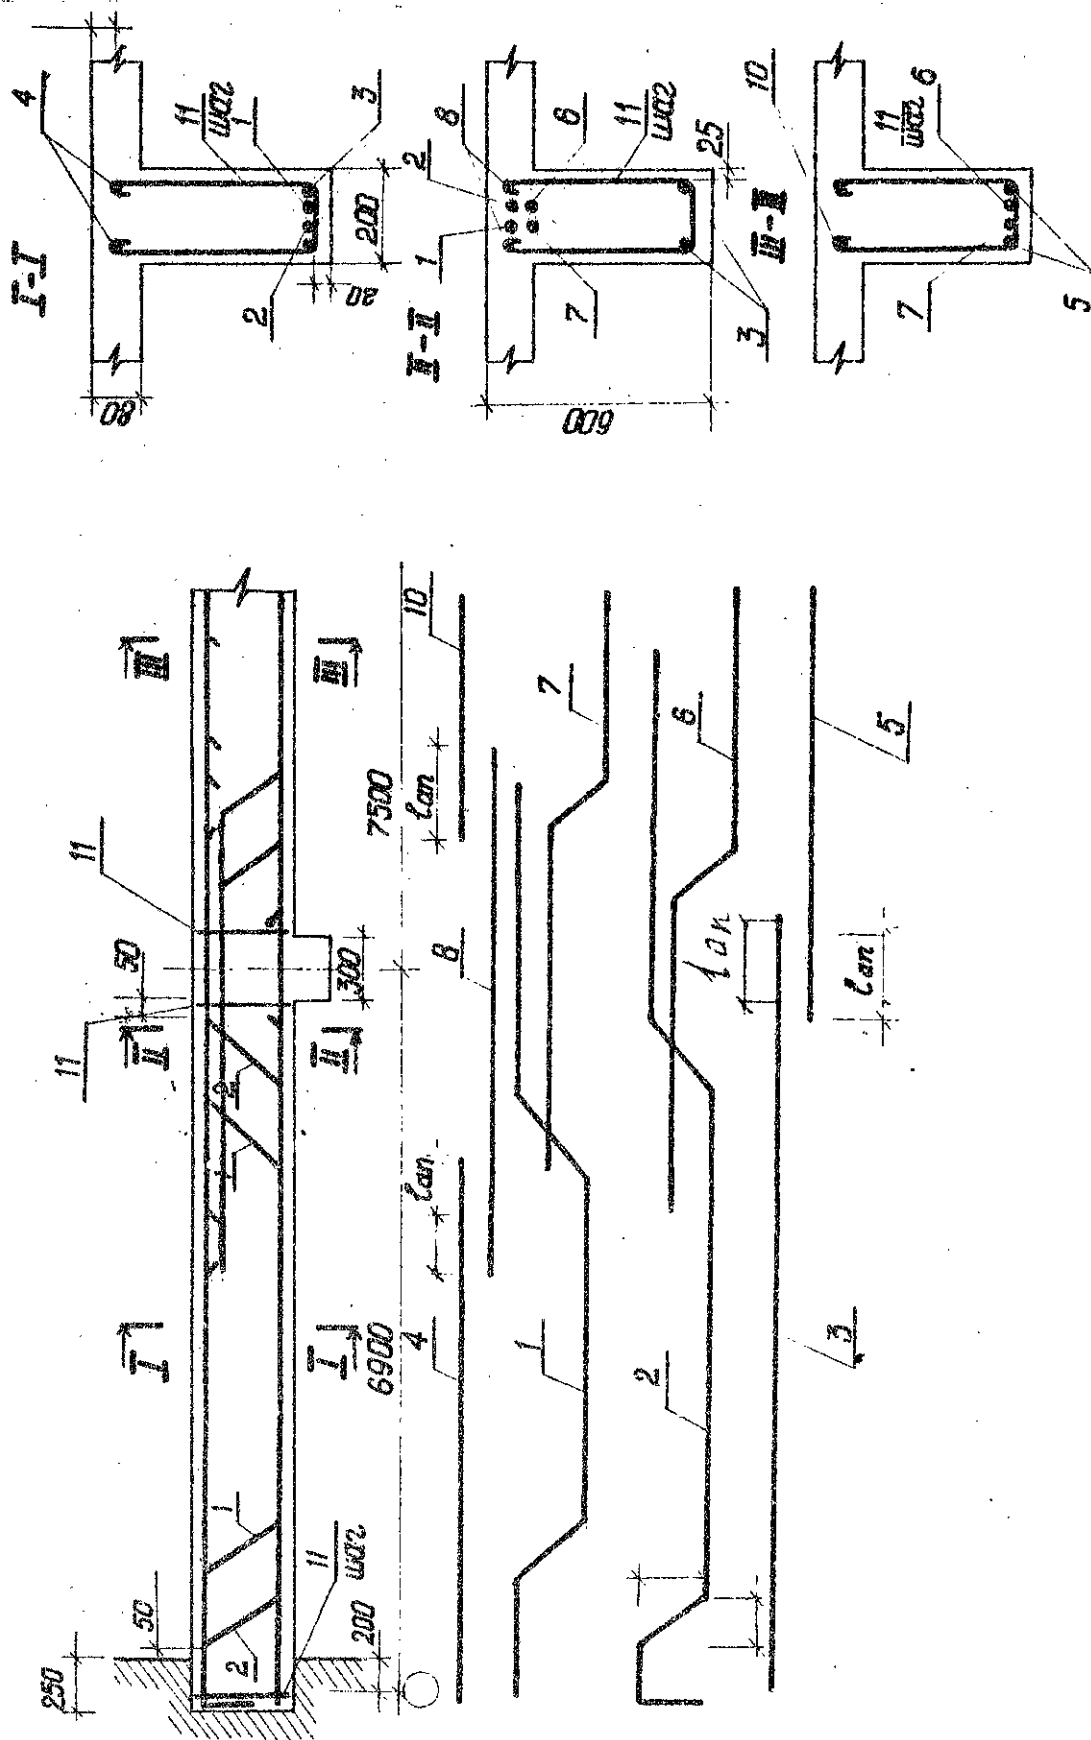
Армирование второстепенной балки вязаными каркасами без углов (отдельные стержни периодического профиля из стали классов А-ІІ, А-ІІІ)
